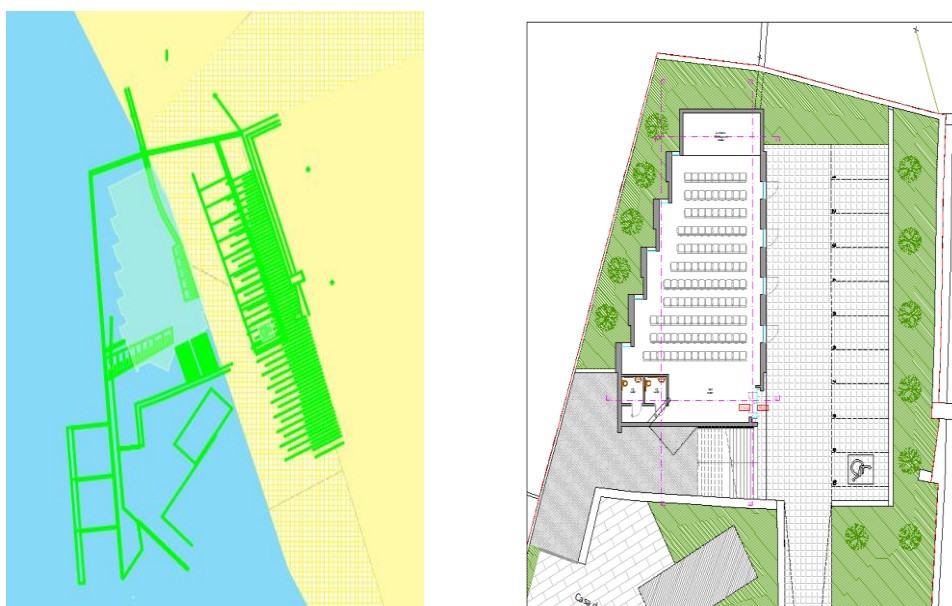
Sobreposição da implantação na Planta de Classificação e Qualificação de Solo e Extrato da planta piso 1
